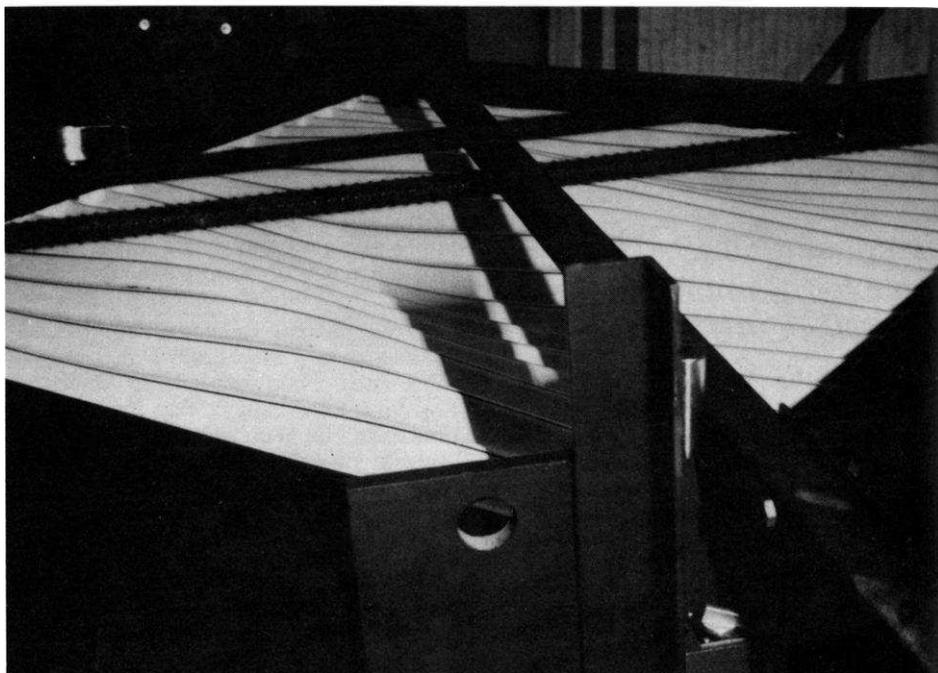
Voilement d'un panneau en tôle plissée.
